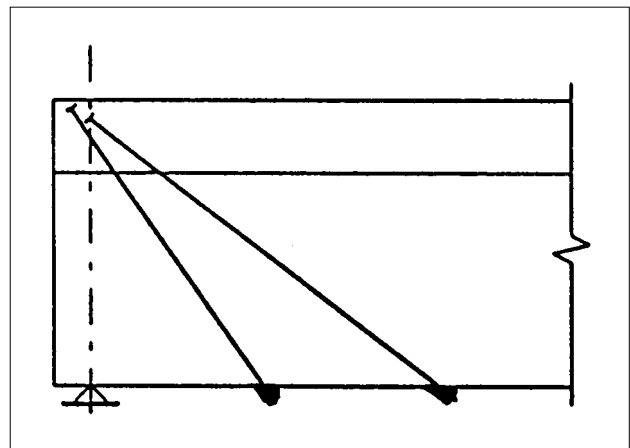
Renforcement au cisaillement au moyen de câbles inclinés.
